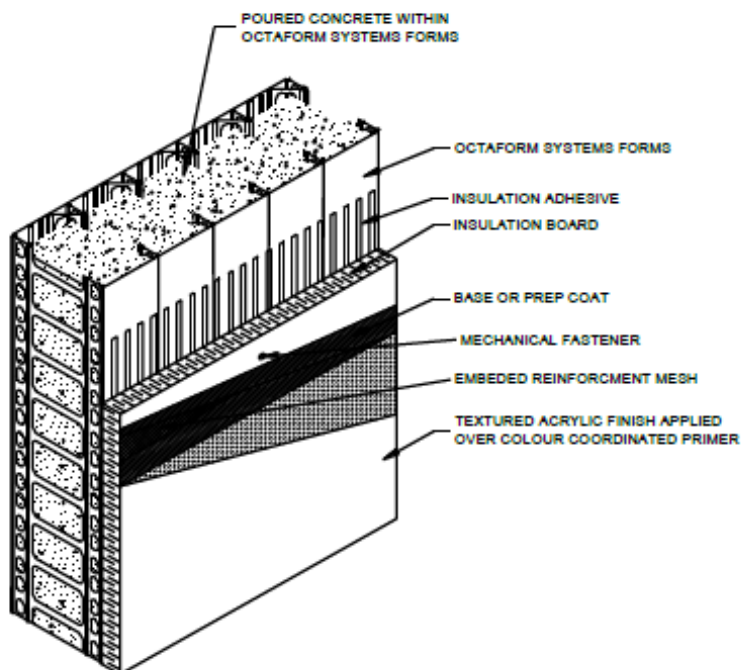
Detalhe de colocação de sistema de isolamento pelo exterior
